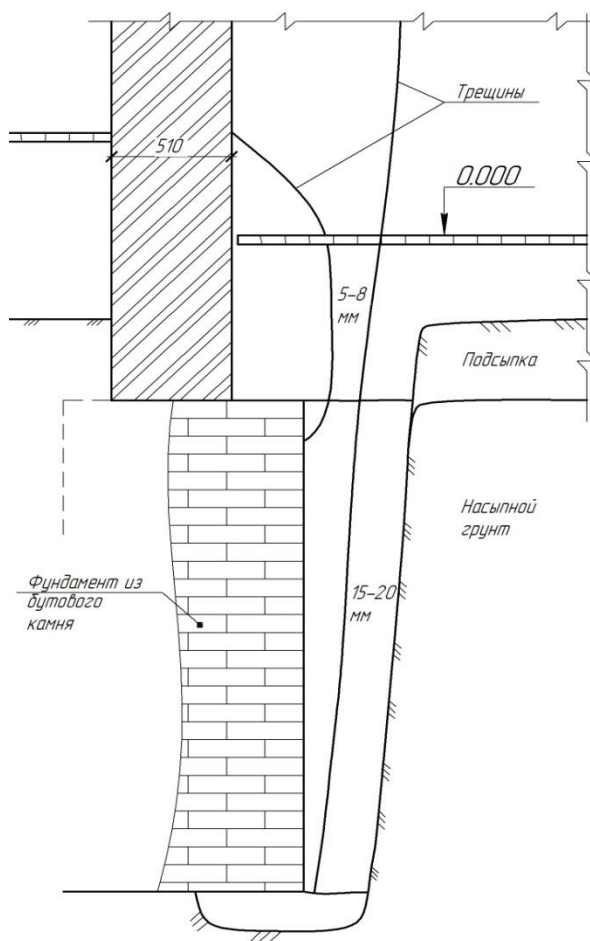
Схема развития трещин в фундаменте торцевой стены по оси 1
